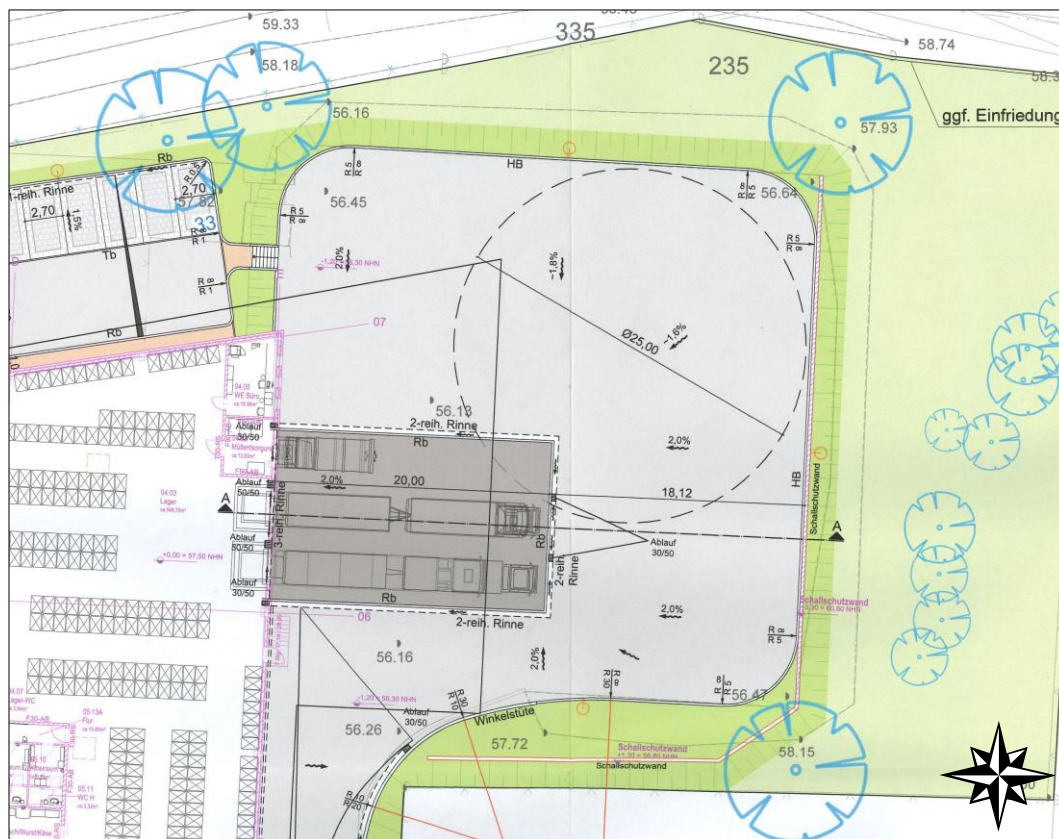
Lage der Lärmschutzwand im nordöstlichen Plangebiet gemäß [3.e]
